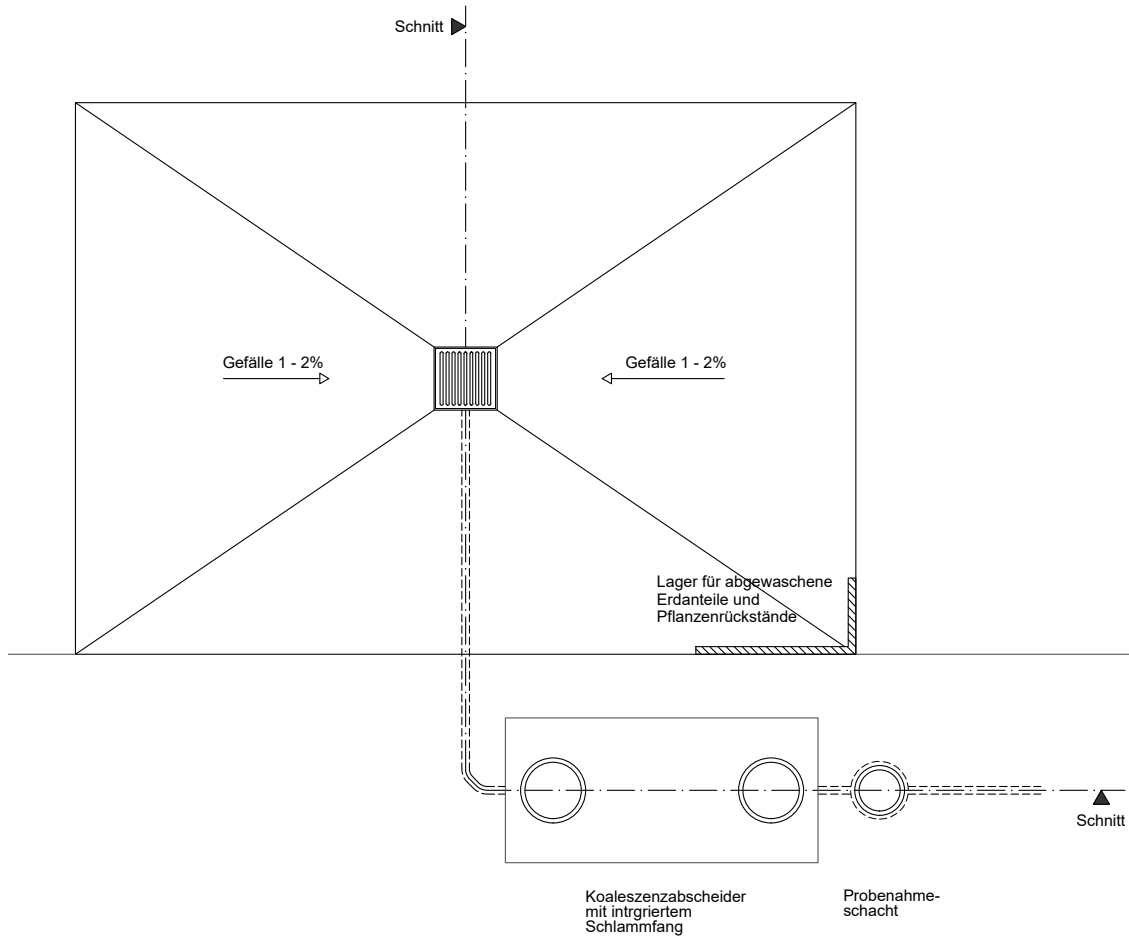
Ein Waschplatz im Grundriss (© Meiforth, LWK Niedersachsen)
